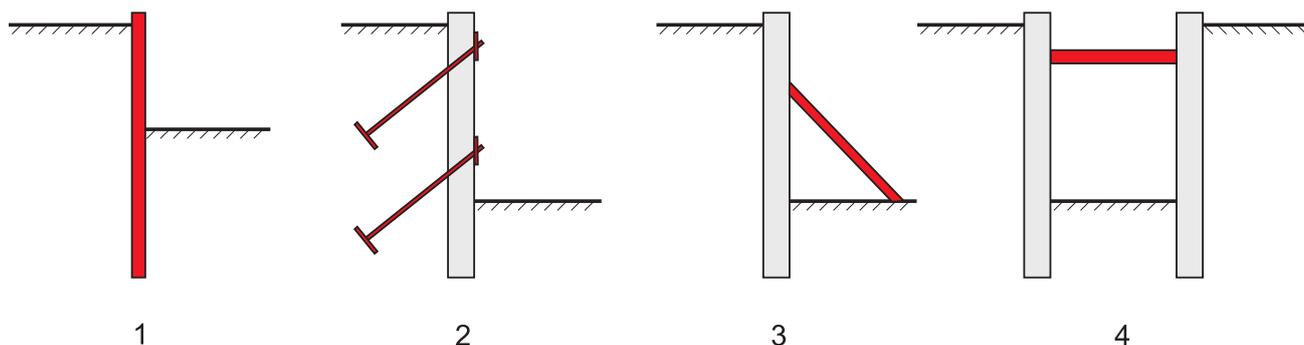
Средства укрепления грунта с помощью стальных конструкций: 1 – стальные шпунты и свайные стенки; 2 – натягаемые анкерные сваи; 3 – подкосы; 4 – распорки и расстрелы
